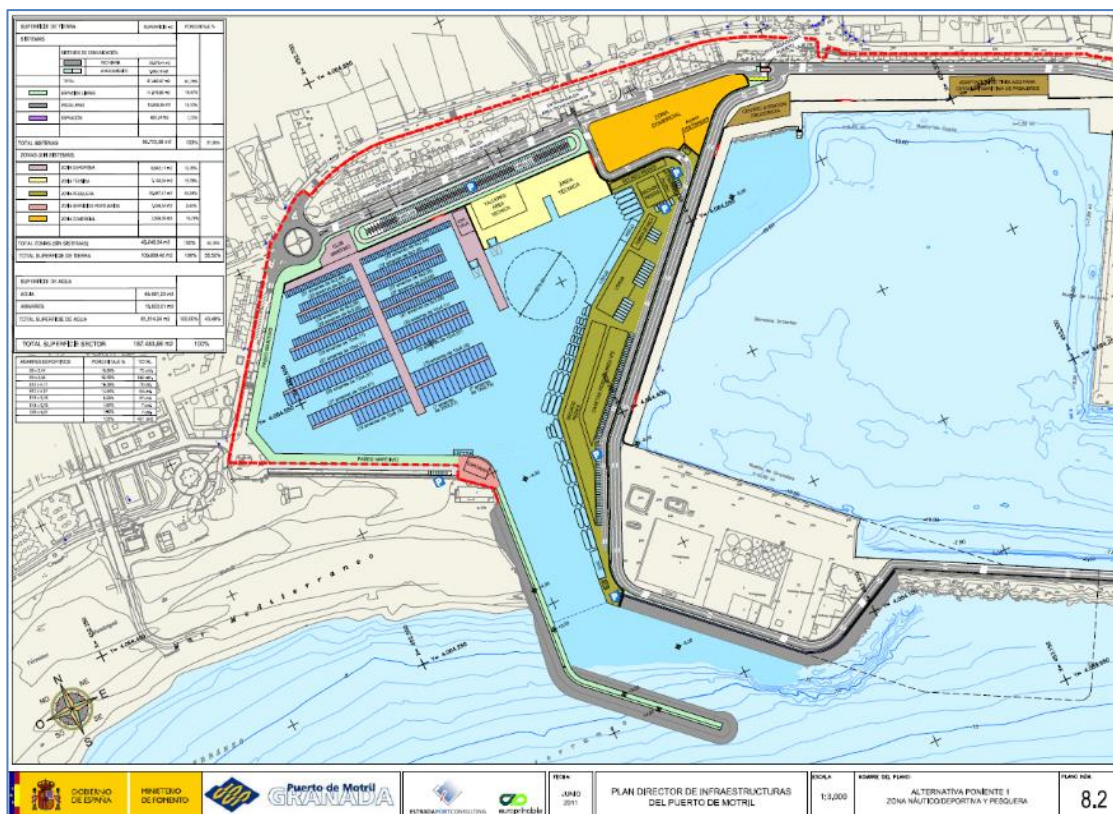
Planta de la dársena pesquero-deportiva de la Alternativa Poniente 1
